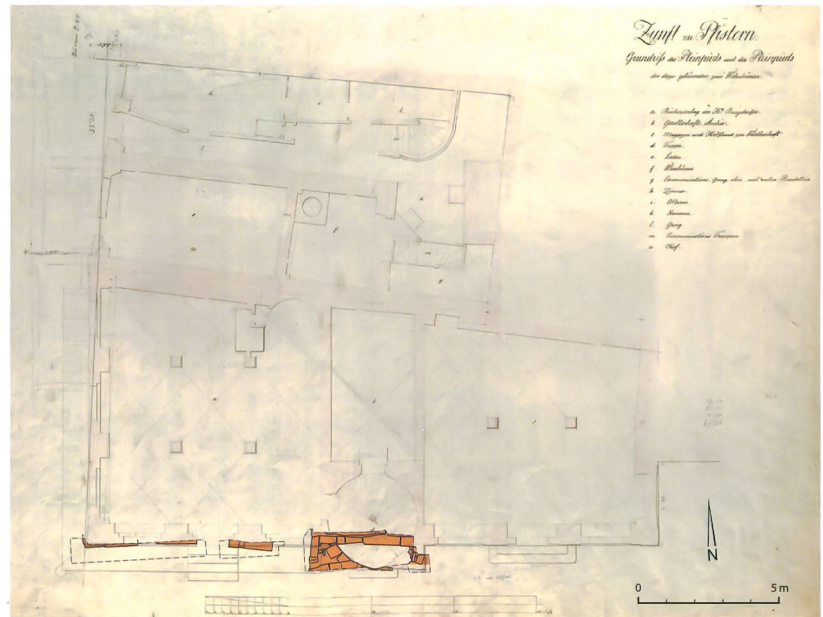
Bern, Kornhausplatz/Theaterplatz/Marktasse. Steingerechter Plan der freigelegten Fundamente des Gesellschaftshauses zu Pfistern vor dem Hintergrund einer Grundrissaufnahme um 1848. Aquarellierte Federzeichnung von Friedrich Studer, Burgergemeinde Bern.
